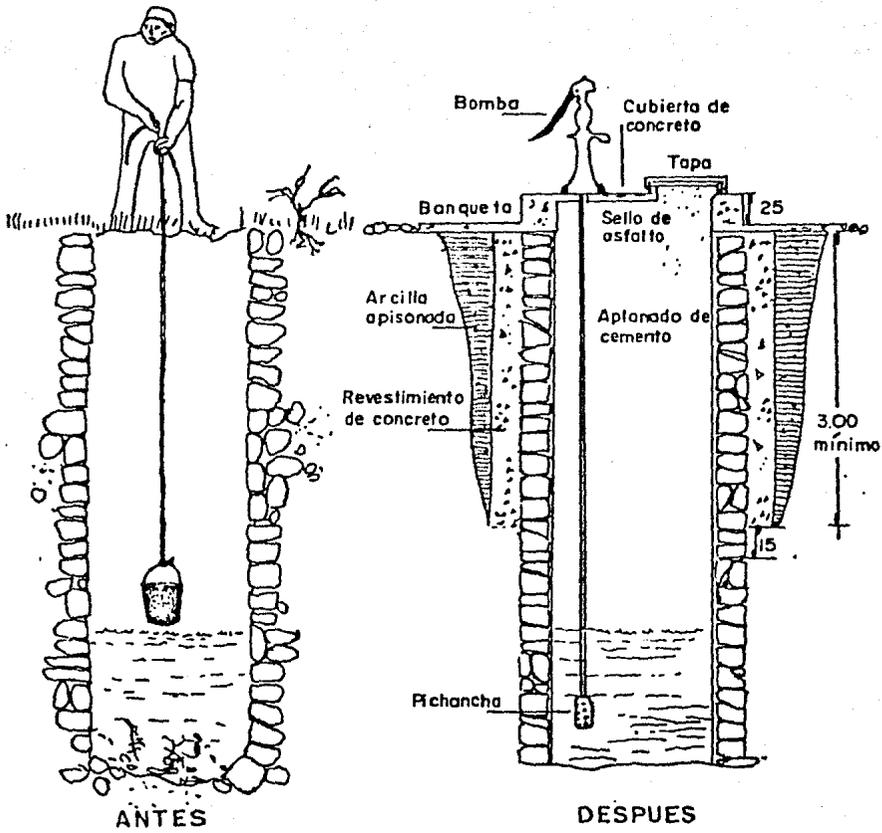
MEJORAMIENTO DE POZOS EXCAVADOS CON ADEME DE PIEDRA.
